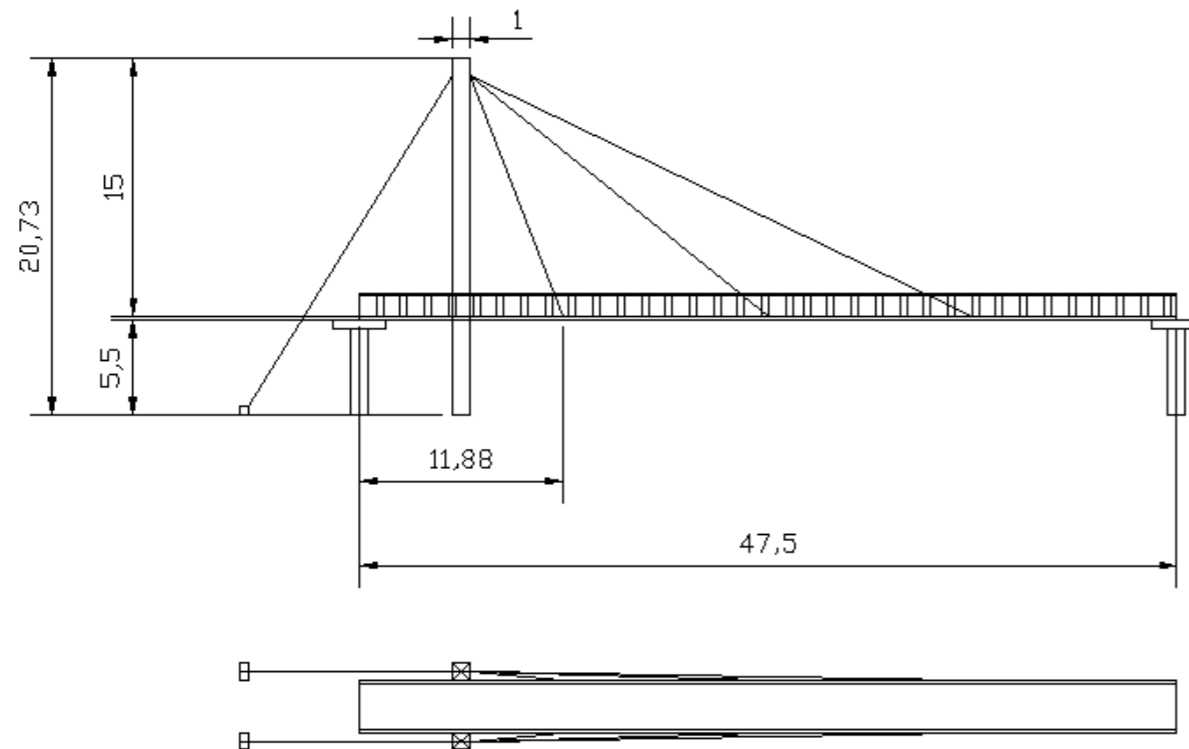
Alzado y planta pasarela peatonal atirantada.
